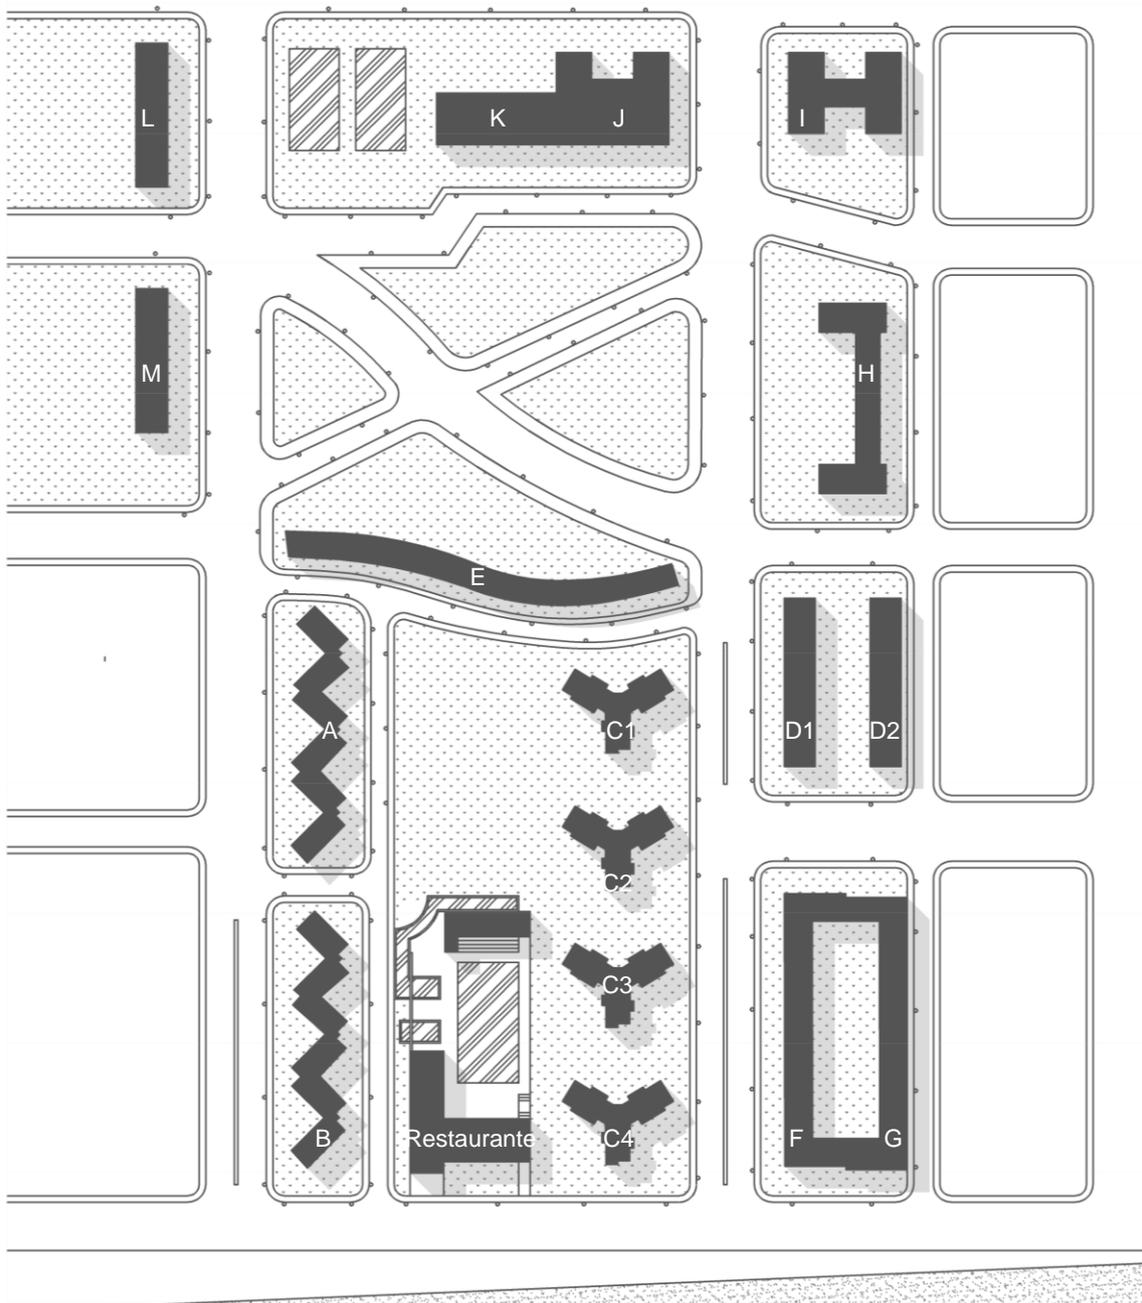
Planta del conjunto, Plan Parcial de Ordenación, 1963. Elaboración propia.
